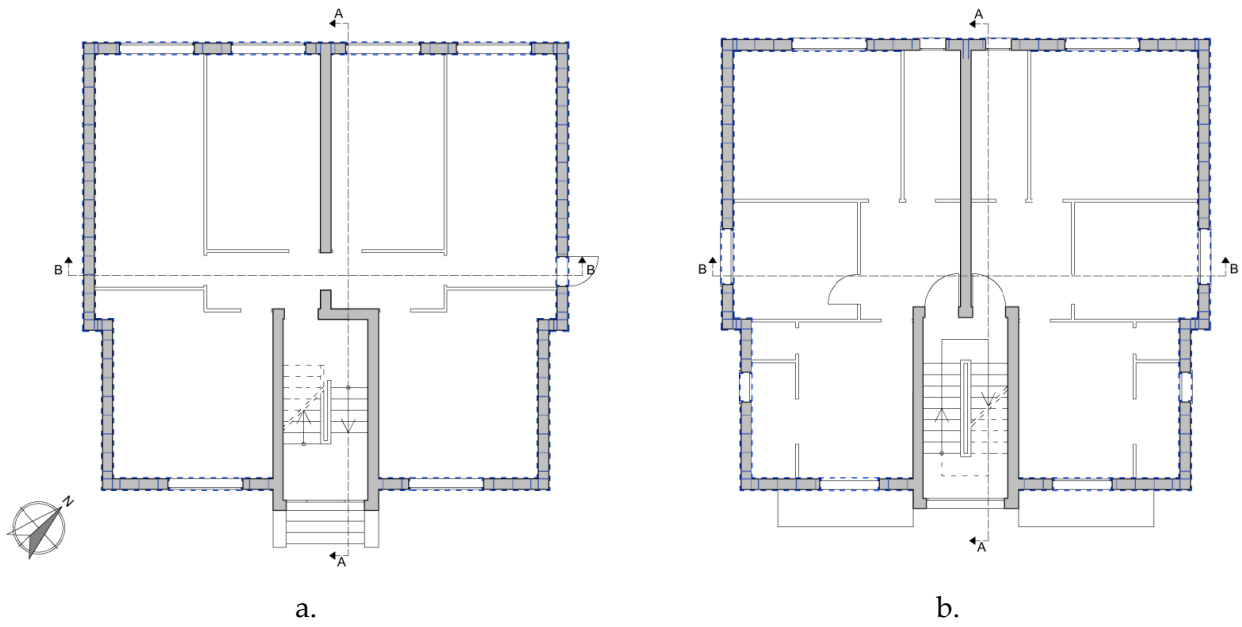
Intonaco armato con rete elettrosaldata su due lati: a) pianta piano terra; b) pianta interpiano.
